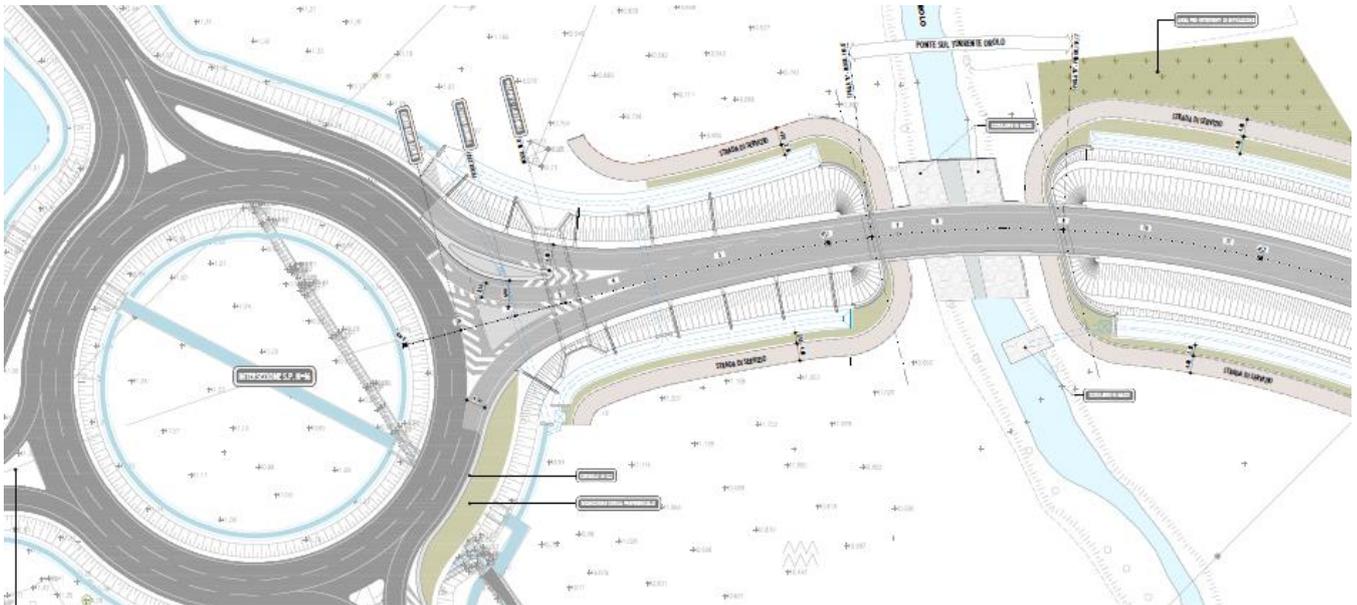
Completamento S.P. n° 46 – stralcio planimetrico
